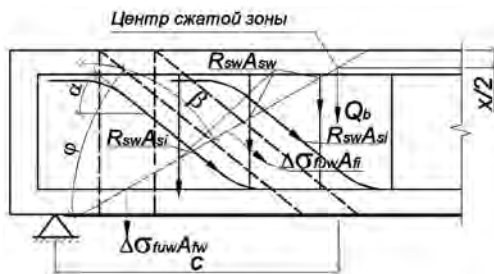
Расчетная схема к определению несущей способности усиленного железобетонного элемента по поперечной силе
